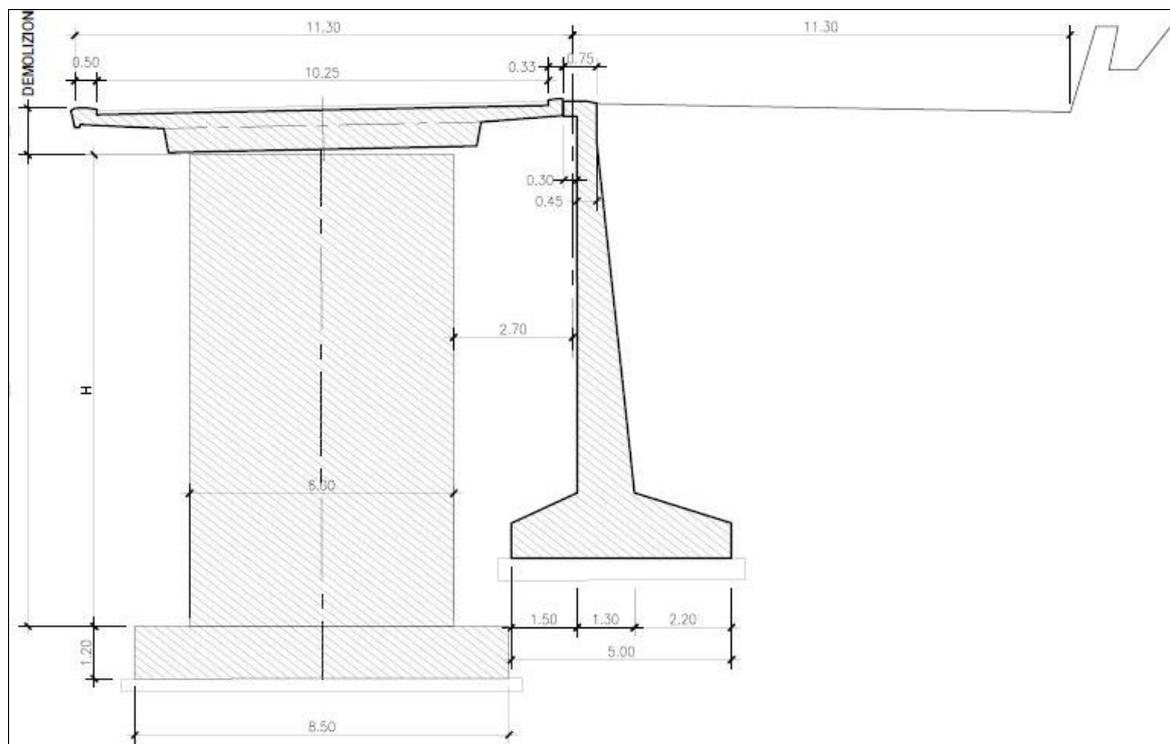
sezione tipica esistente dell'emiviadotto fuggeto
